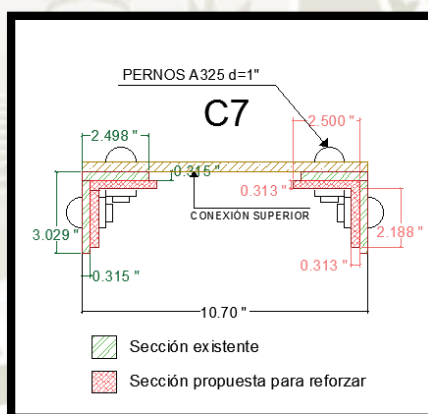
Secciones para reforzamiento de C7 – Compuesta. Arriostre
